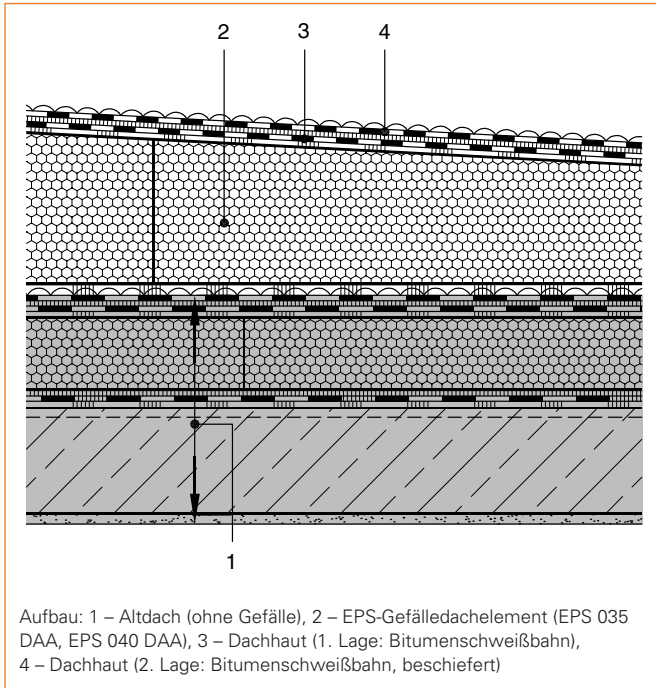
Sanierungsvariante: massives Flachdach mit Zusatzdämmung
